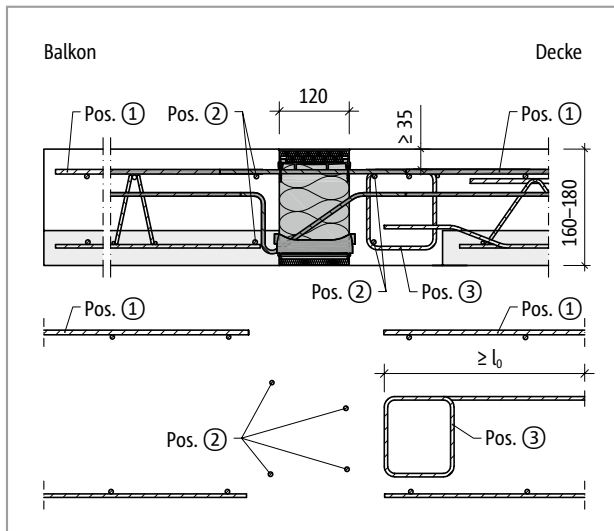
Schöck Isokorb® XT Typ K-F: Bauseitige Bewehrung bei Balkonplattendicke  $h = 160\text{--}180\text{ mm}$
